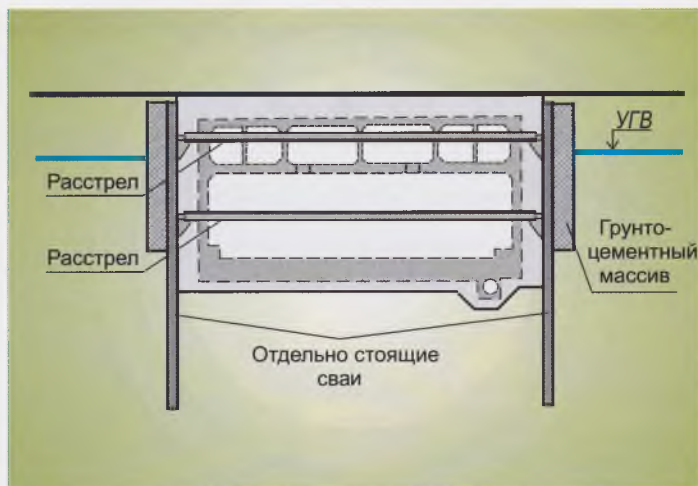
Распорное крепление котлована (ширина котлована до 30-32 м)
